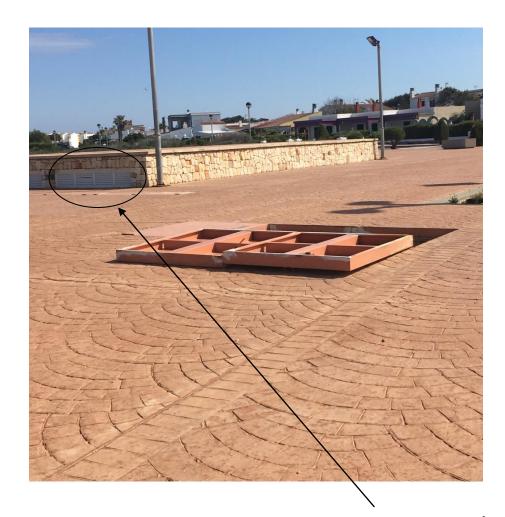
Cubierta de maquinaria en zona cantara y rejillas de ventilación
